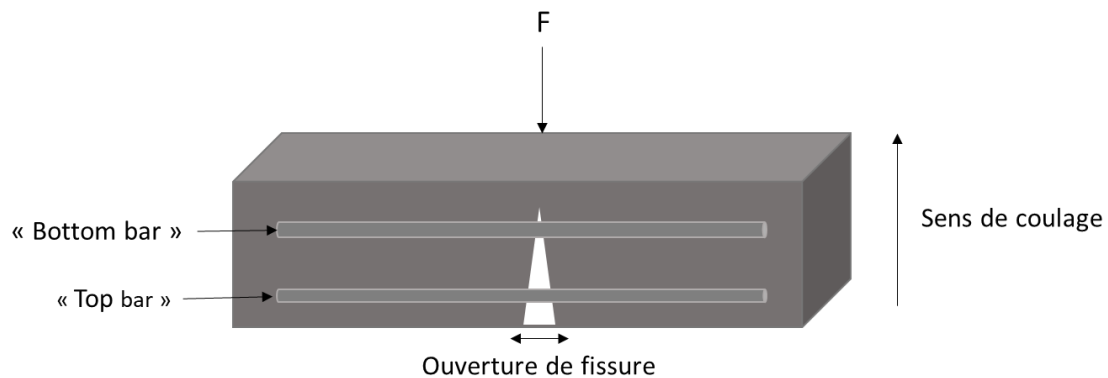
Schémas de la pré-fissuration d'une poutrelle en flexion 3 points
